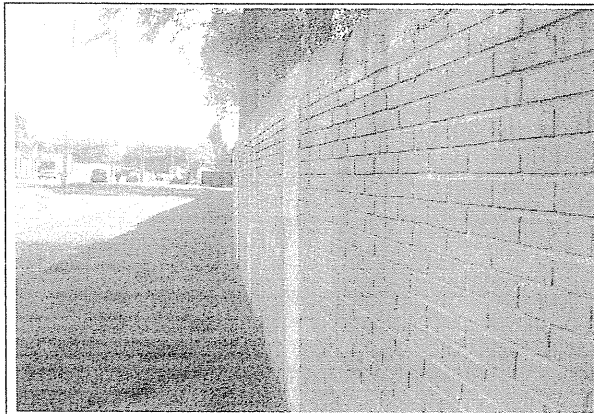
Cara externa del muro de cerramiento en buenas condiciones.
